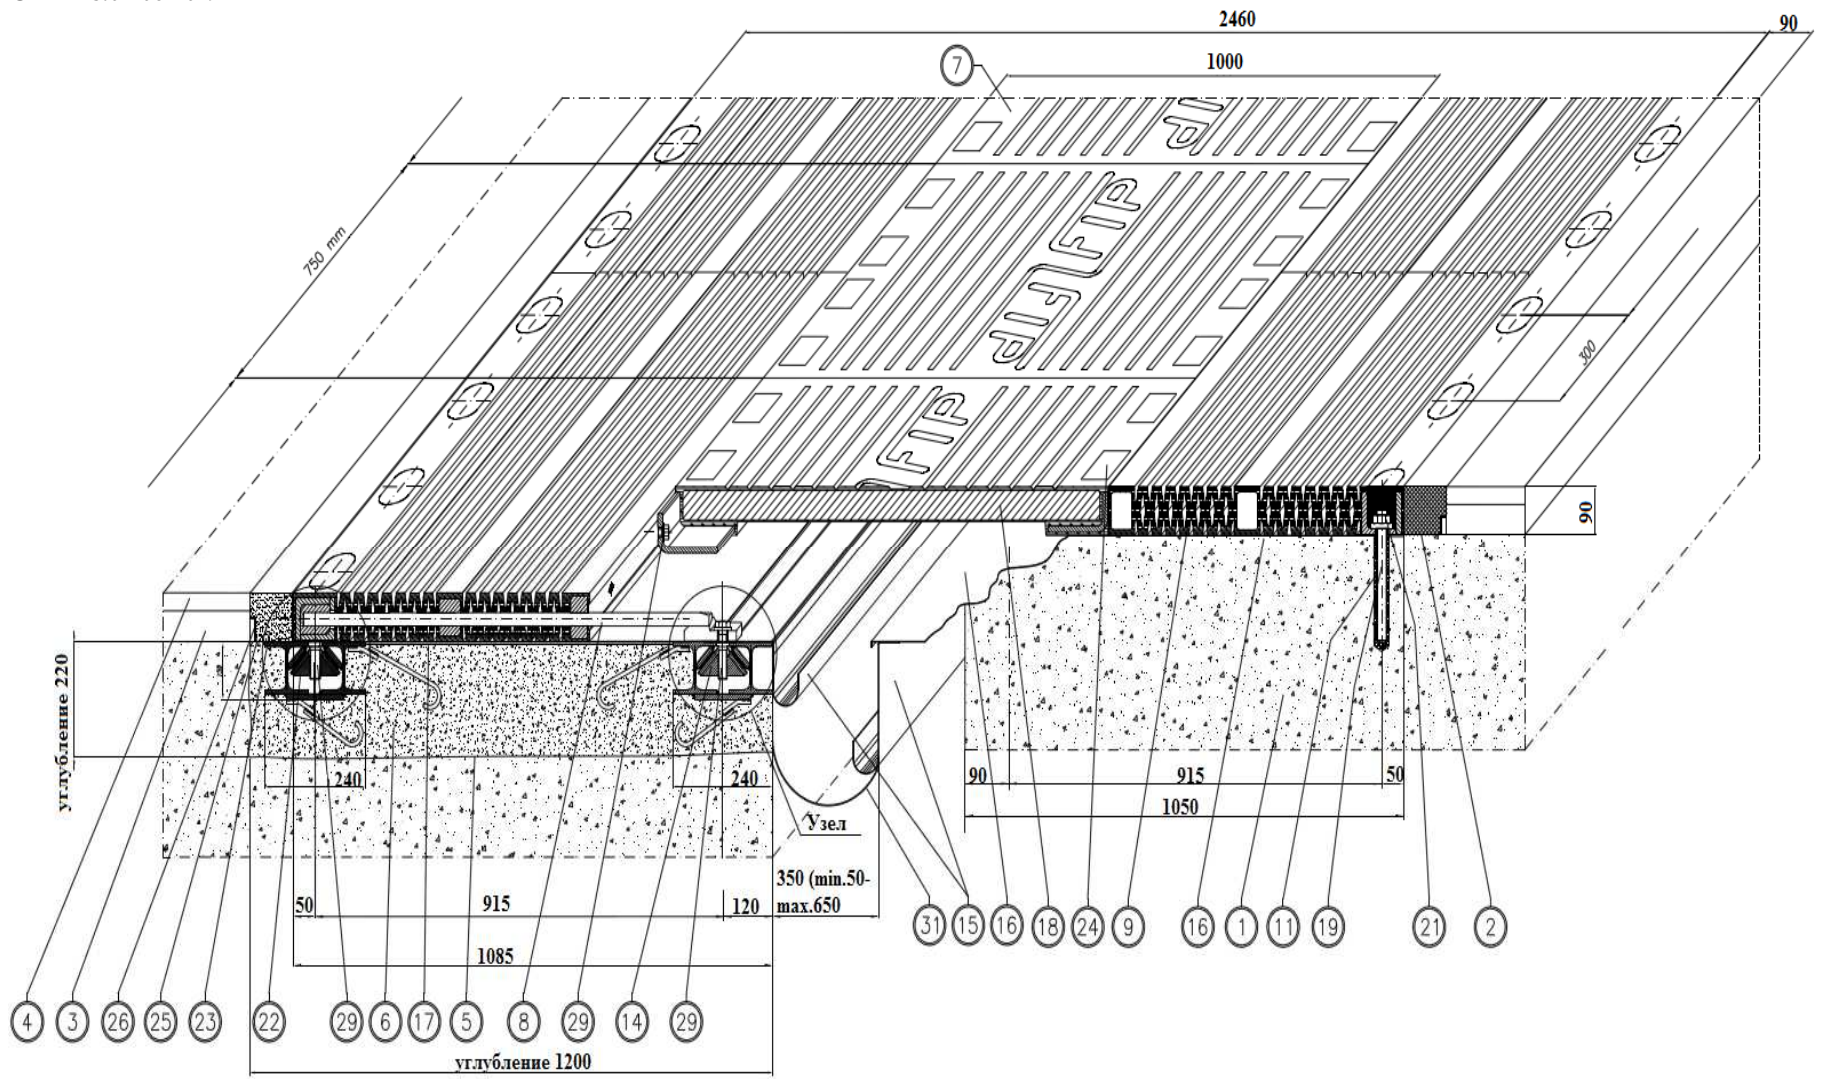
Конструкция деформационного шва между железобетонным устоем и железобетонной плитой пролетного строения моста
